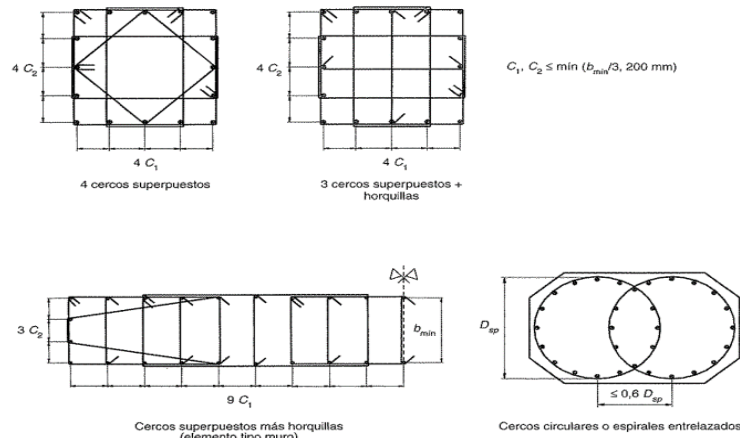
Disposición geométrica relativas a las armaduras transversales de confinamiento en zonas de rotulas plásticas
